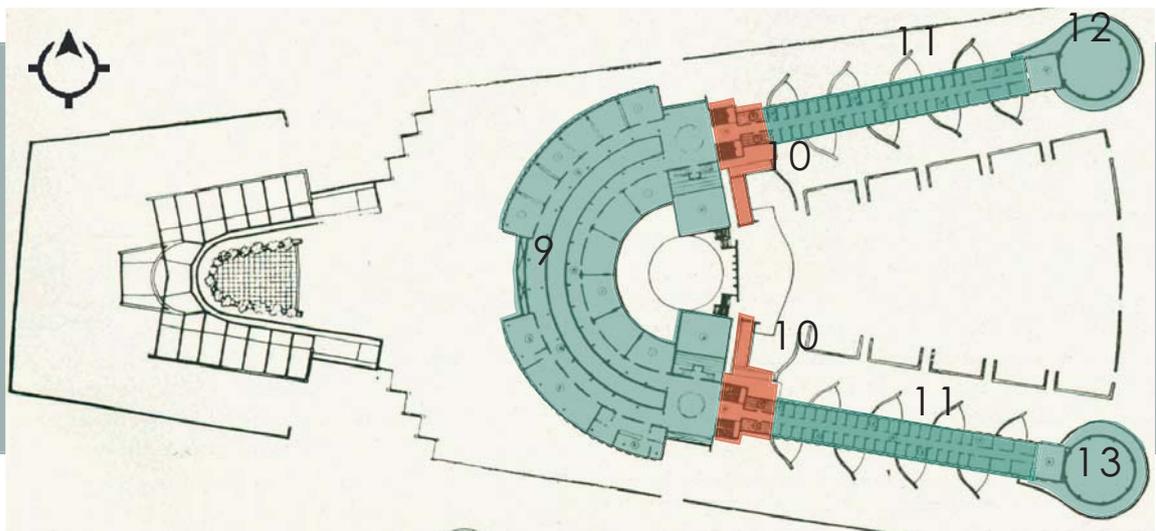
PLANTA ARQUITECTÓNICA, PRIMER NIVEL.
